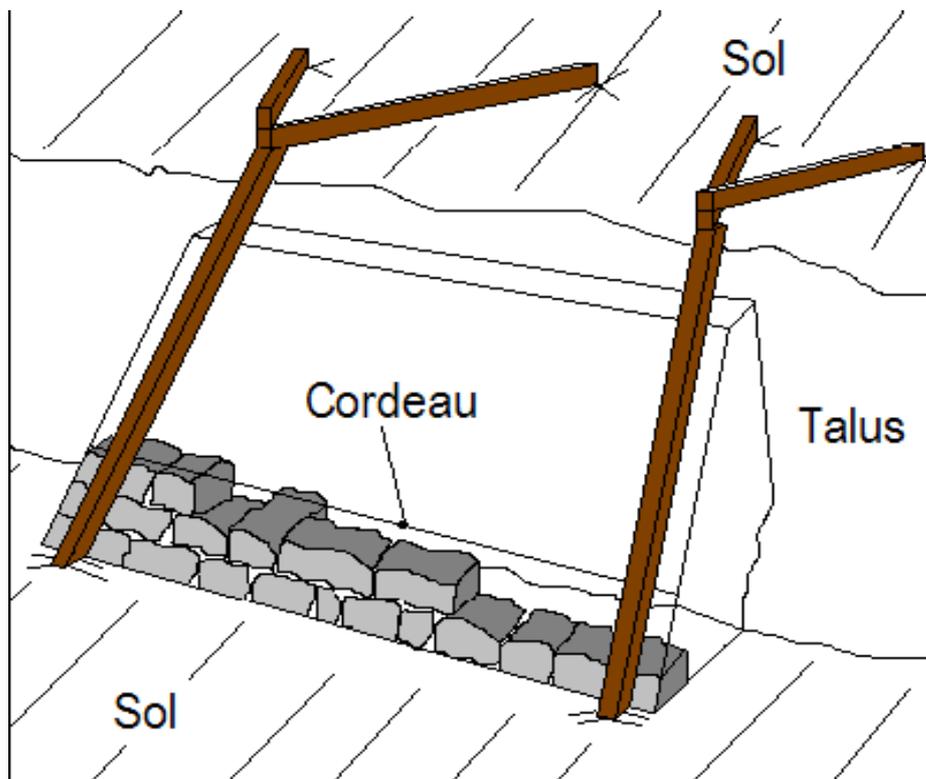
Disposition des bois croisés pour la construction des murs en pierre sèche
